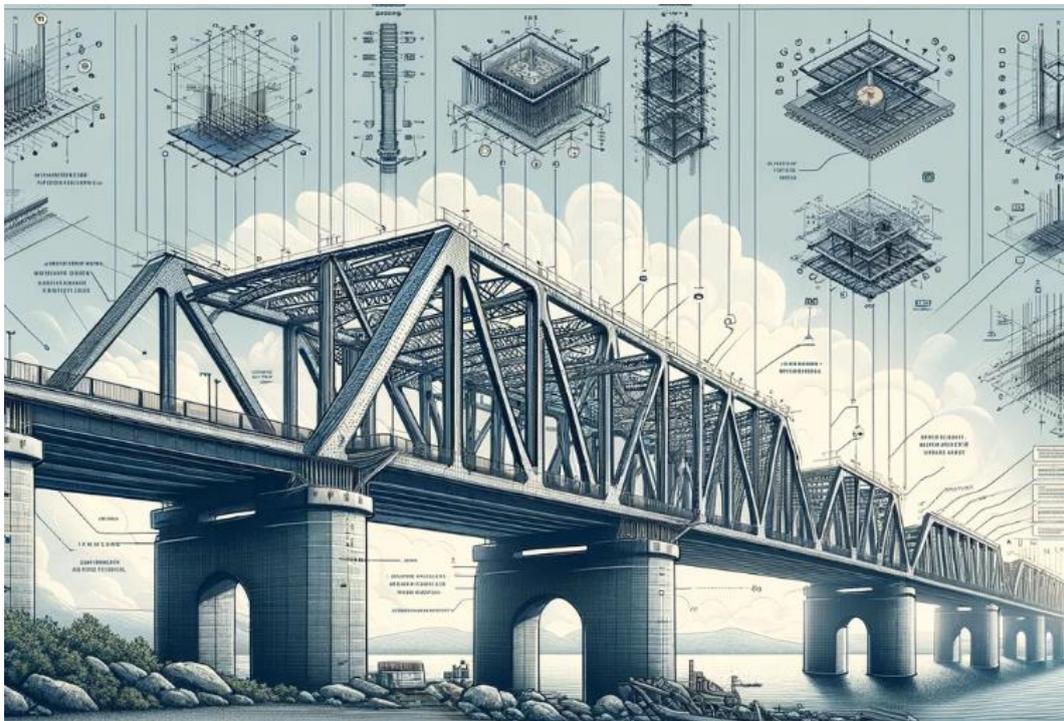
Diseño conceptual y los parámetros de ingeniería considerados en la construcción de estructuras de puentes de acero.
